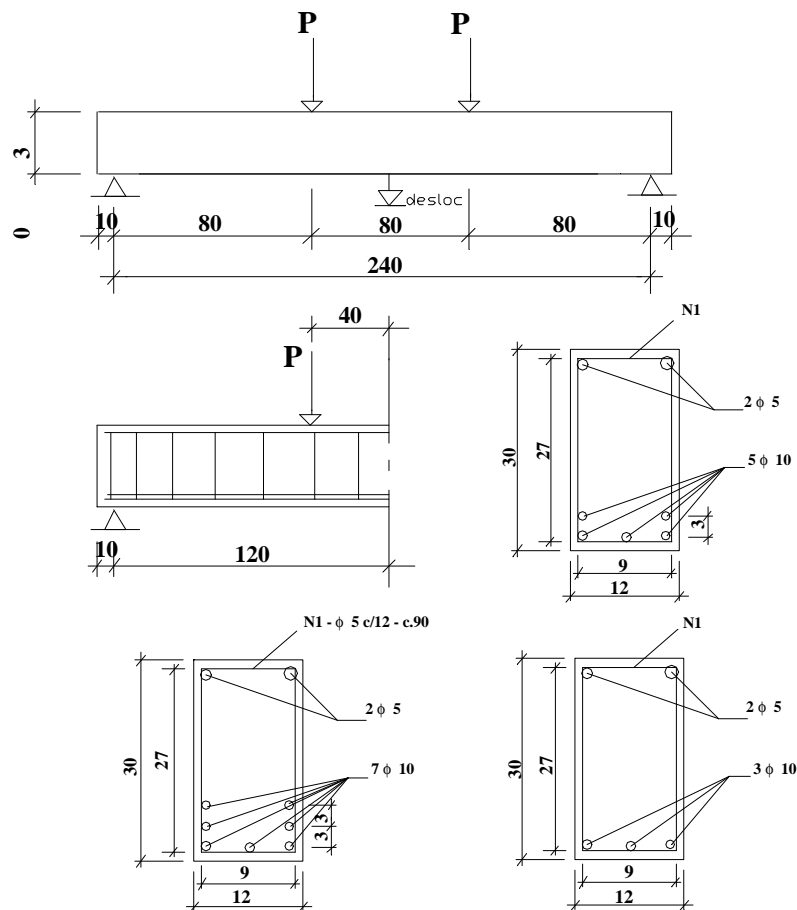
Geometria das vigas ensaiadas em ÁLVARES (1993).
